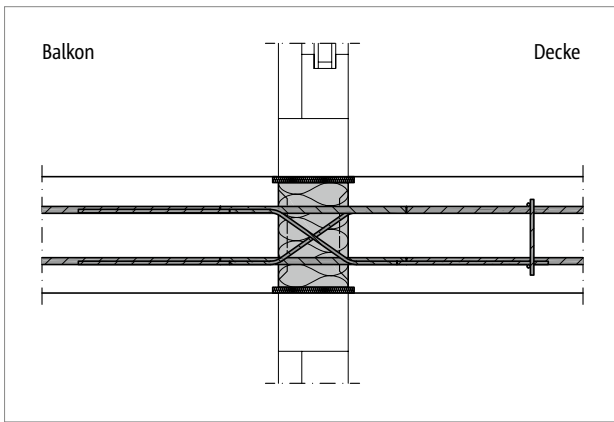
Schöck Isokorb® XT Typ DL: Einbauschnitt; einachsig gespannte Decke
